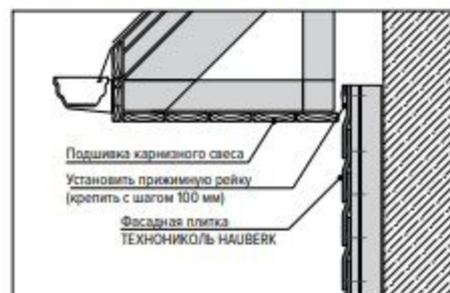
Монтаж верхнего ряда под карнизным свесом. Вариант 1
